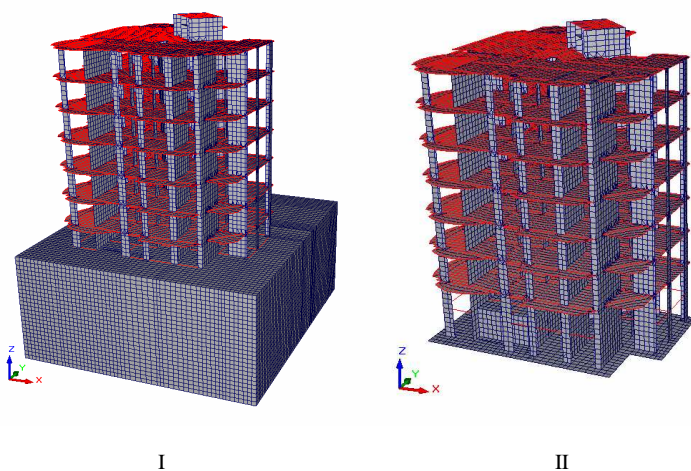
Вариант (В) – конечно-элементные модели расчетных схем 7-этажных каркасно-стеновых монолитных железобетонных зданий с подвалом: I – здание с основанием (В₁, В₂, В₃, В₄, В₅); II – здание без основания (В₆).
